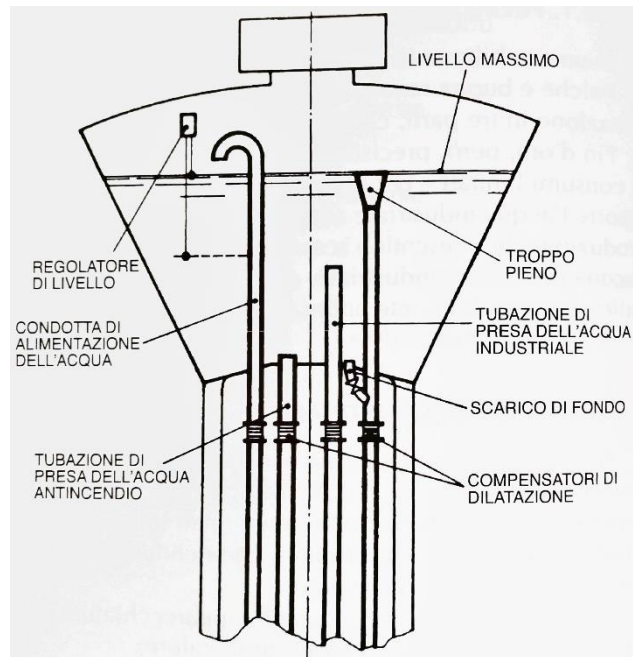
Sezione di un serbatoio sopraelevato
